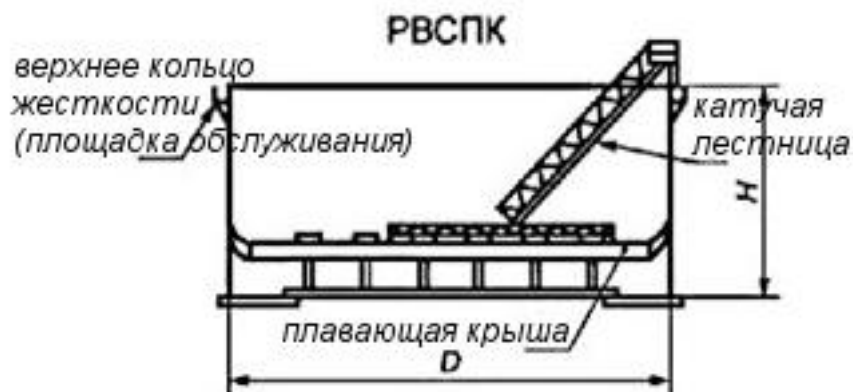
Схема стального вертикального резервуара с плавающей крышей (РВСПК);
